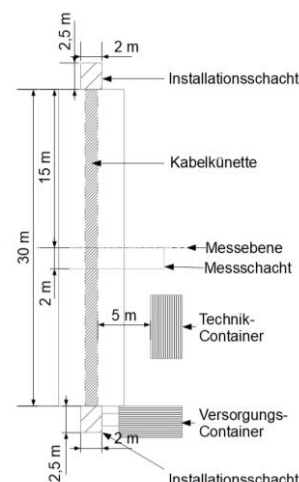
Grundriss des 400 kV - Kabelversuchs
